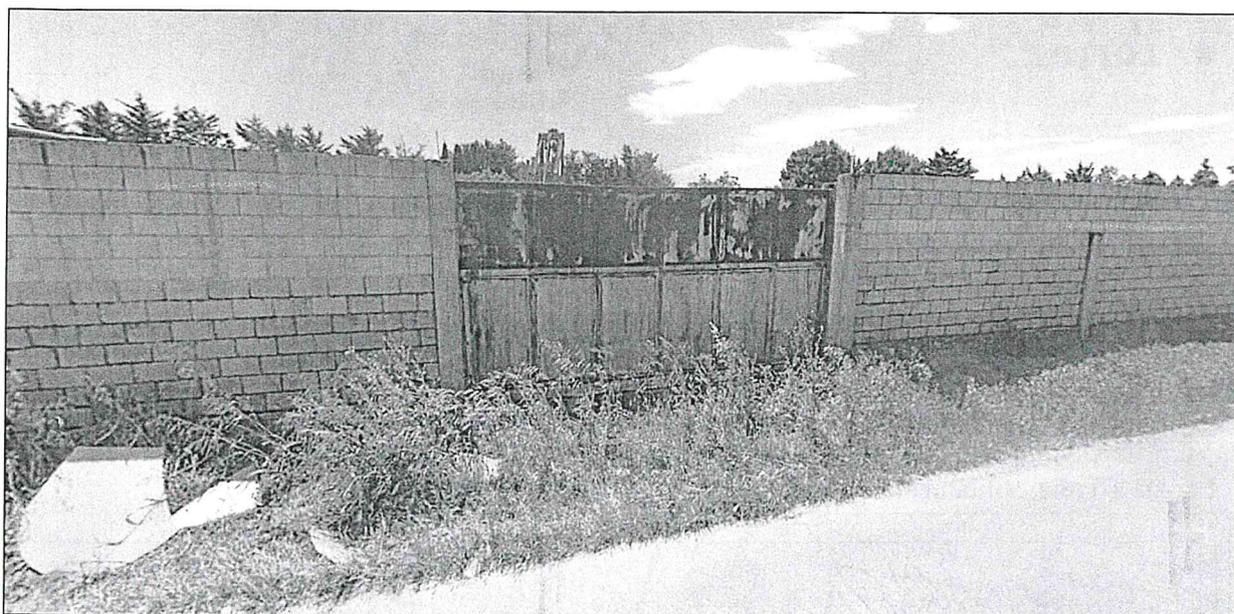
Cannello di accesso al Lotto E dalla Strada Vicinale Diga Luigi Capaccio.
